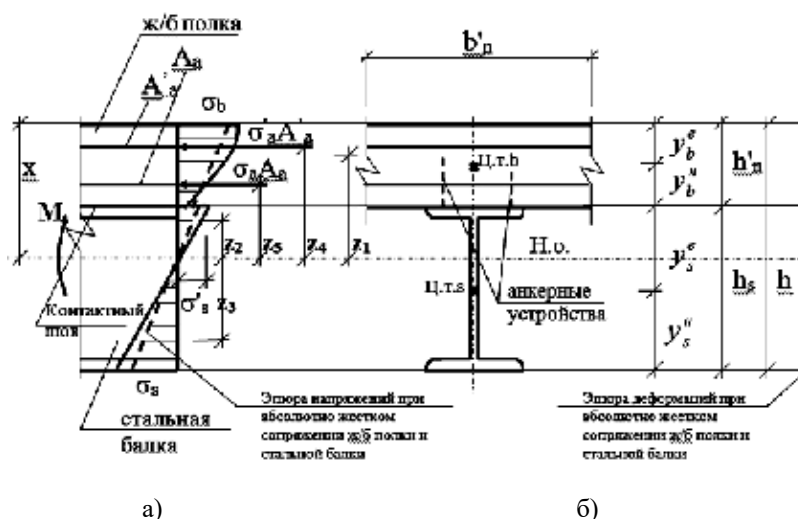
Расчетная схема сталежелезобетонного сечения со стальными ребрами:
